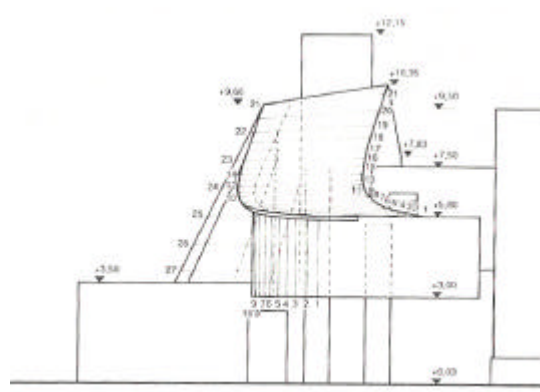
Frank Gehry, Fabrikationshalle, 1987-1989, Dachdetail der Nordecke von Nordwesten
